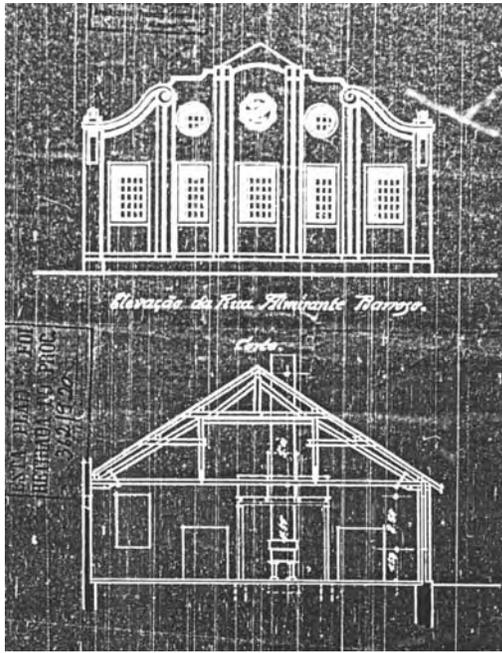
Pavilhão da Fundação na Rua Alm. Barroso, 1920, Wiederspahn.
